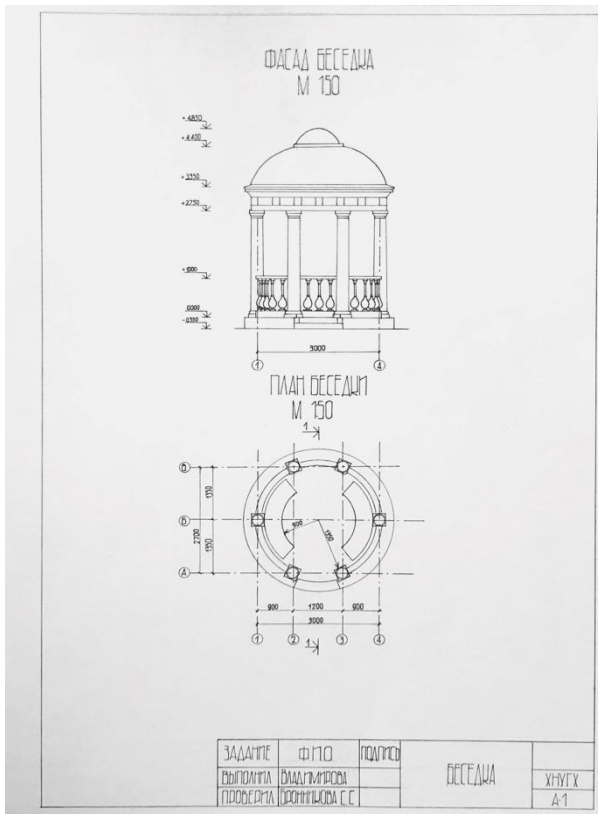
Креслення архітектурного об'єкту (план, головний фасад, розріз, вид зверху)»
